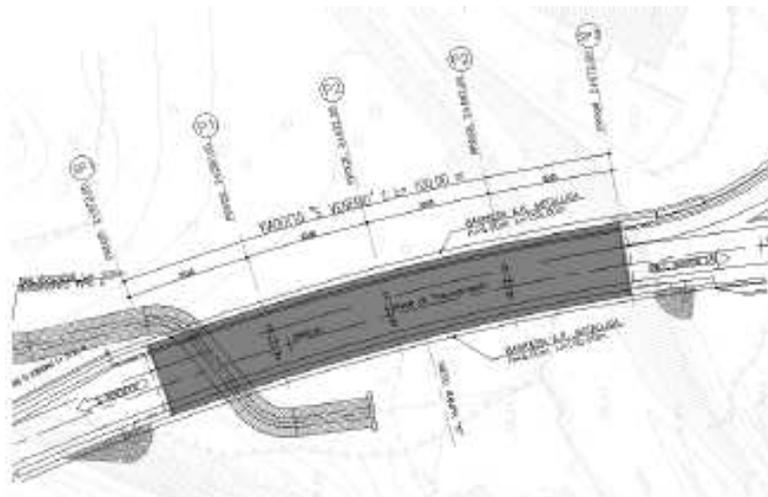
Viadotto S.Venerio I – Planimetria generale
